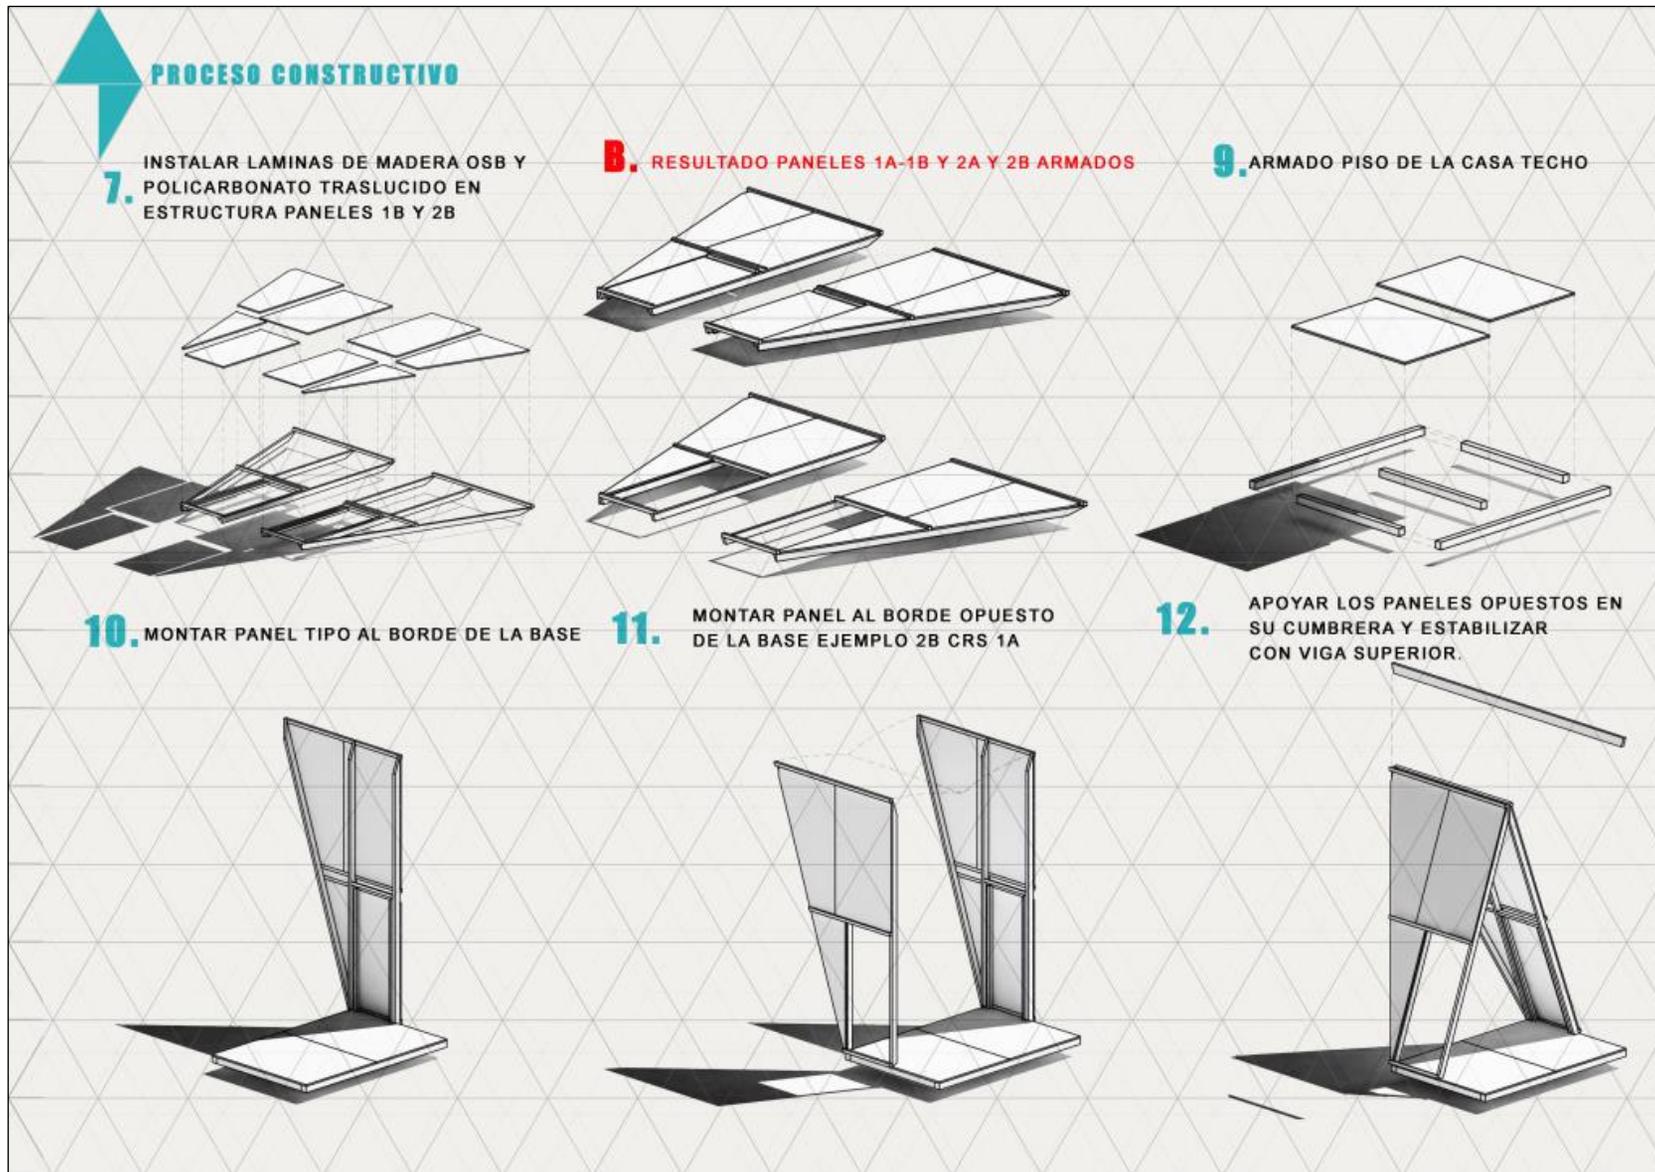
Proceso de armado de la vivienda emergente Casa Techo
